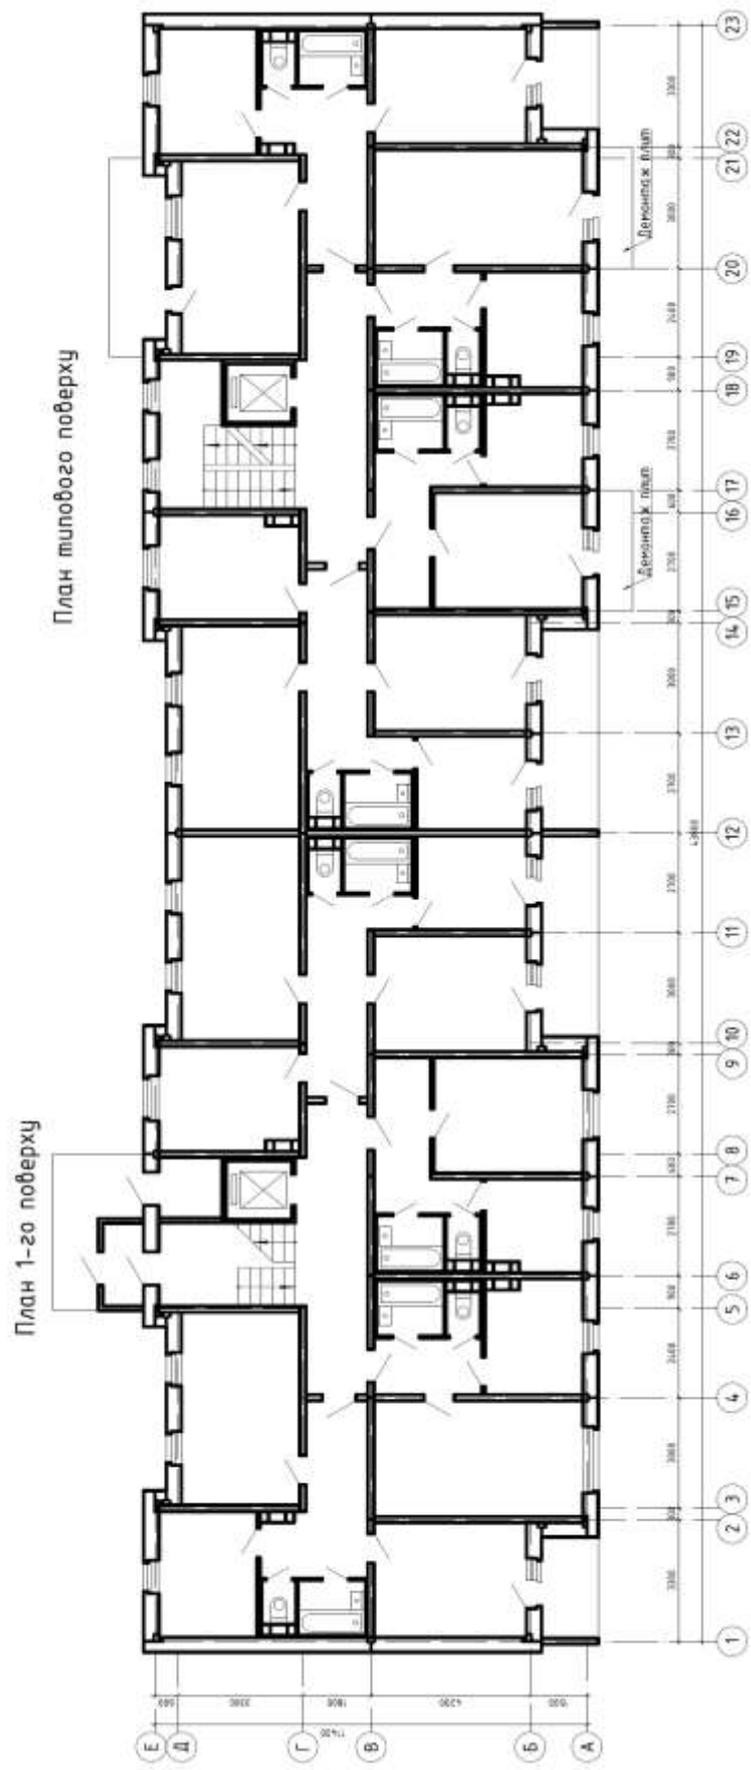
Типова секція панельної дев'ятиповерхової житлової будівлі (плани першого та типового поверхів)
